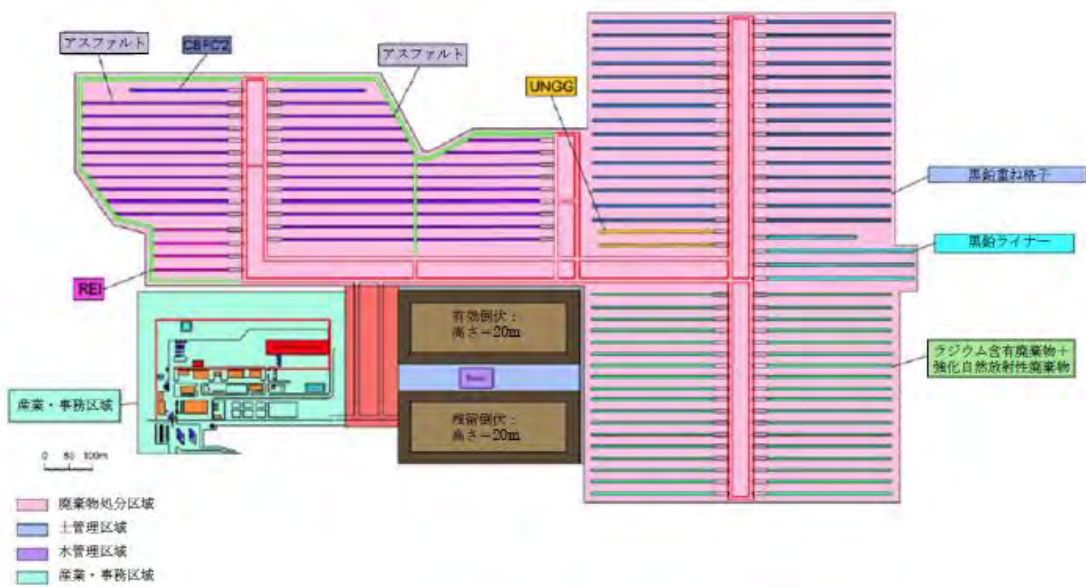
地下坑道を掘削するオプションの平面図 [3]
